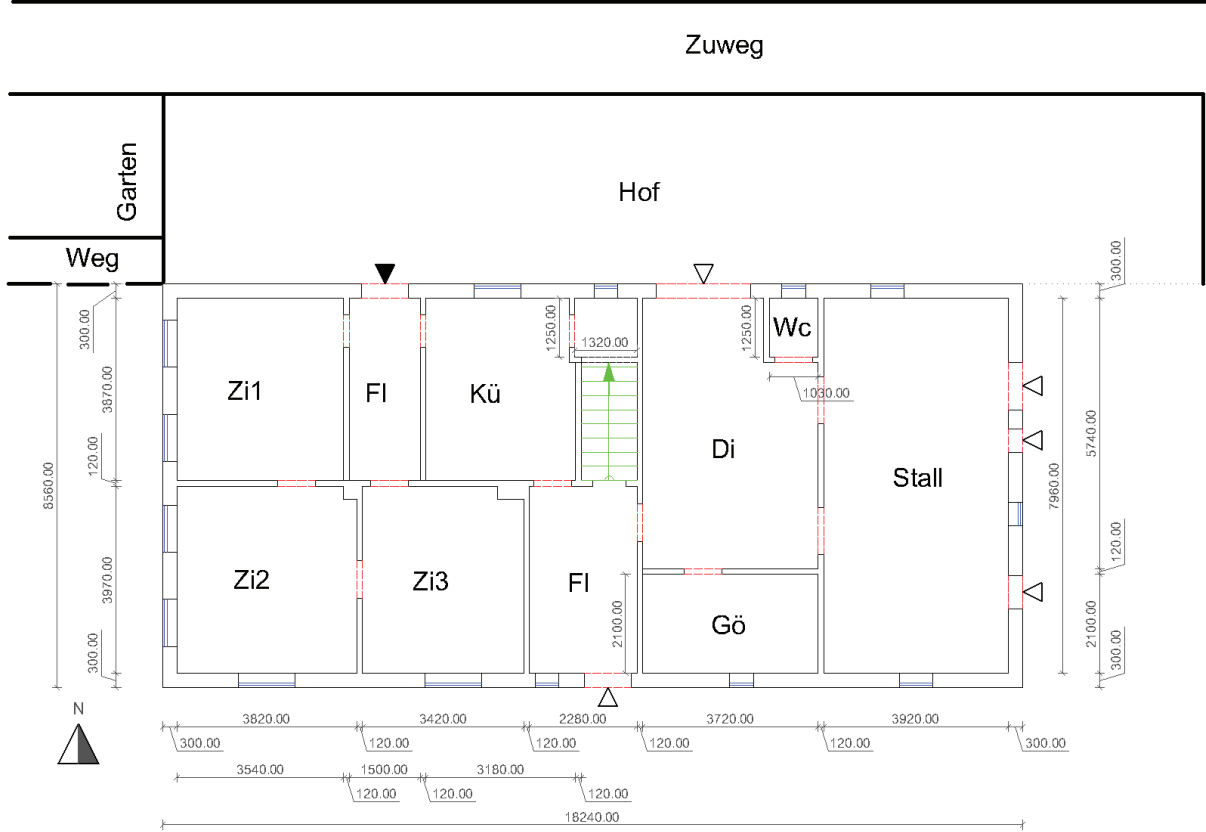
Grundriss Erdgeschoss 1938. Ein Original lag nicht vor, weshalb dieser Grundriss auf der Grundlage des Grundrisses von 1978 rekonstruiert wurde. Digitalisiert von Rostek (2023).
